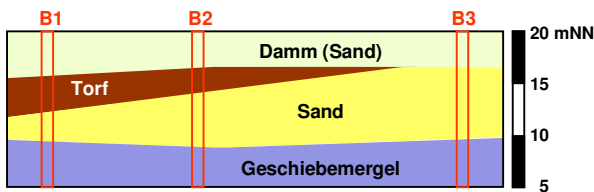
Beispiel Kanalausbau: Erstes Baugrundmodell
